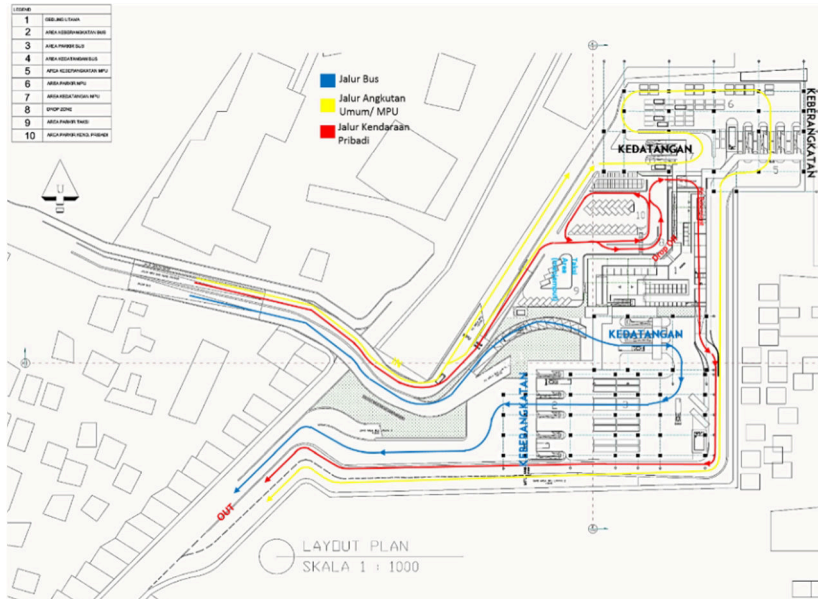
Fasilitas Terminal Pondok Cabe Lama
